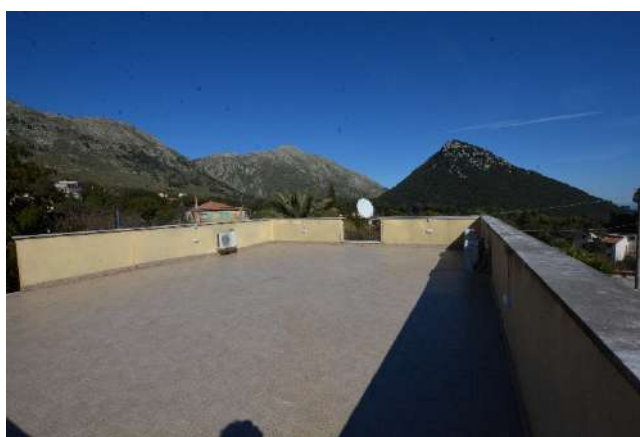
(Allegato 9) Lastrico solare di 1° piano – Fig. 5, p.lla 517, sub.3
